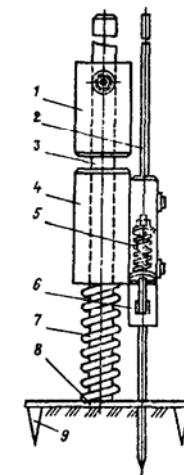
Приспособление для забивки заземлителей, опирающееся на землю:
